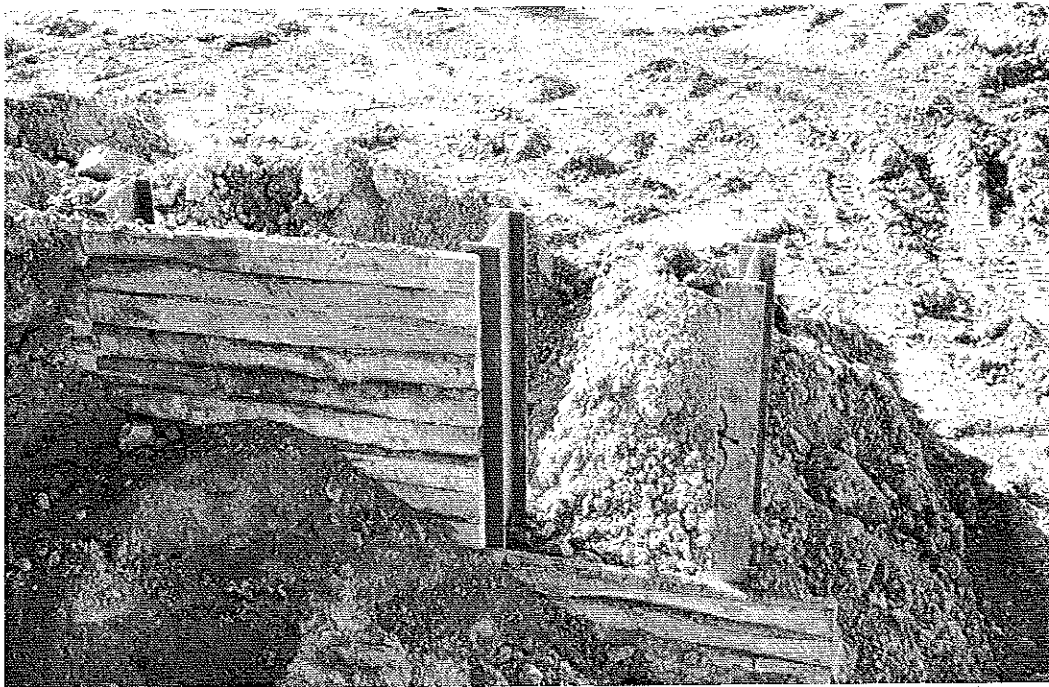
Paroi berlinoise en protection de fouille. © J. Putatti
